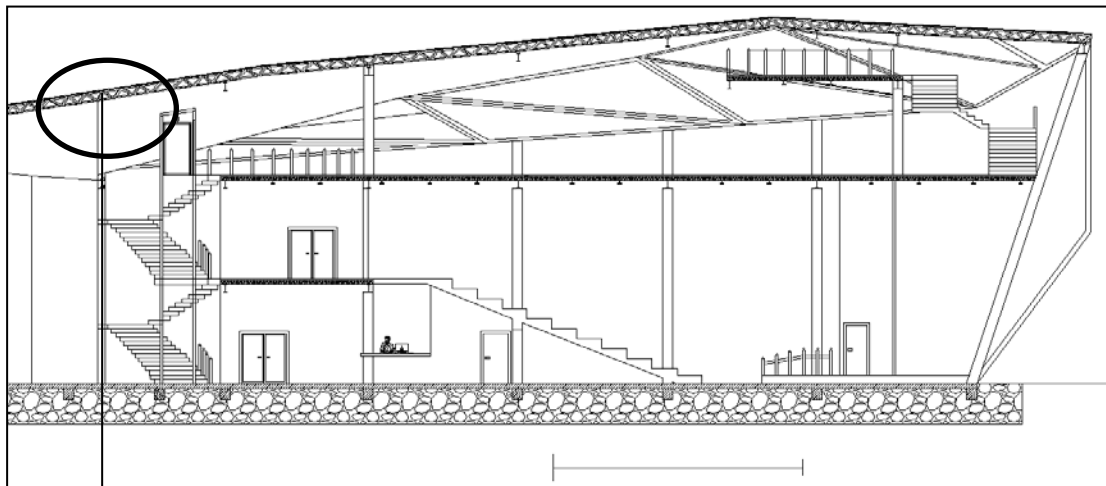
coupe de l'unité éducative qui montre la poutre treillis
